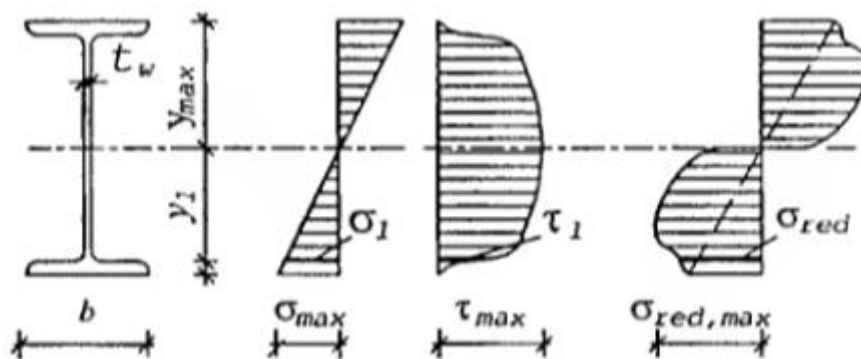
Епюри напружень в двотавровому перерізі балки
